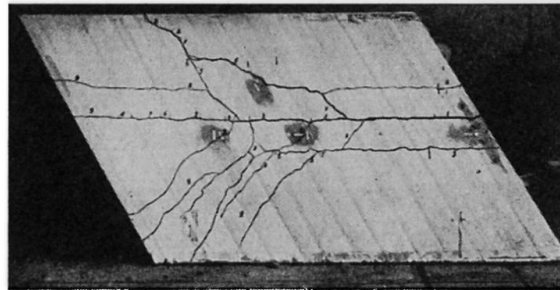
Fissures sur la face inférieure de la dalle simplement appuyée le long de trois côtés. Dalle n° 3.
